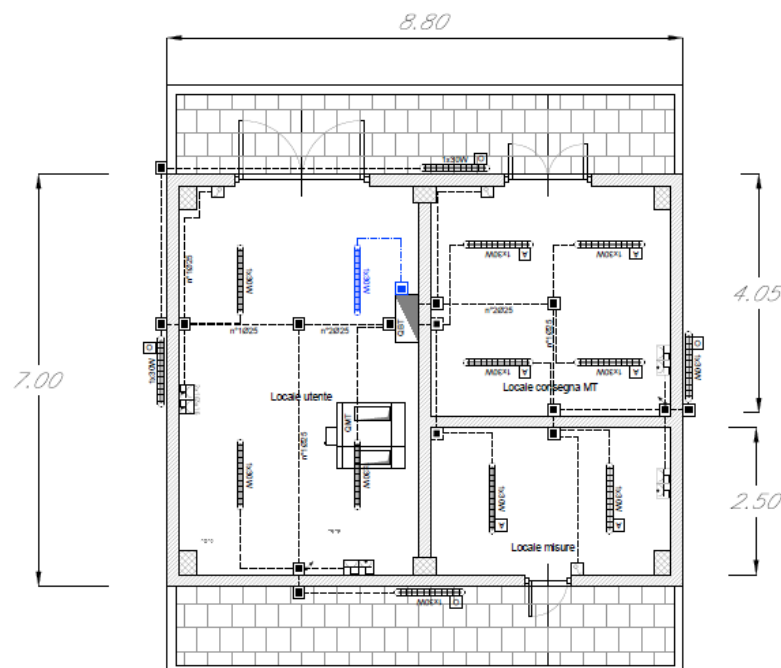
Pianta - Locale tipologico consegna energia (FA05_1, FA06_1, FA07_1, FA08_1)
